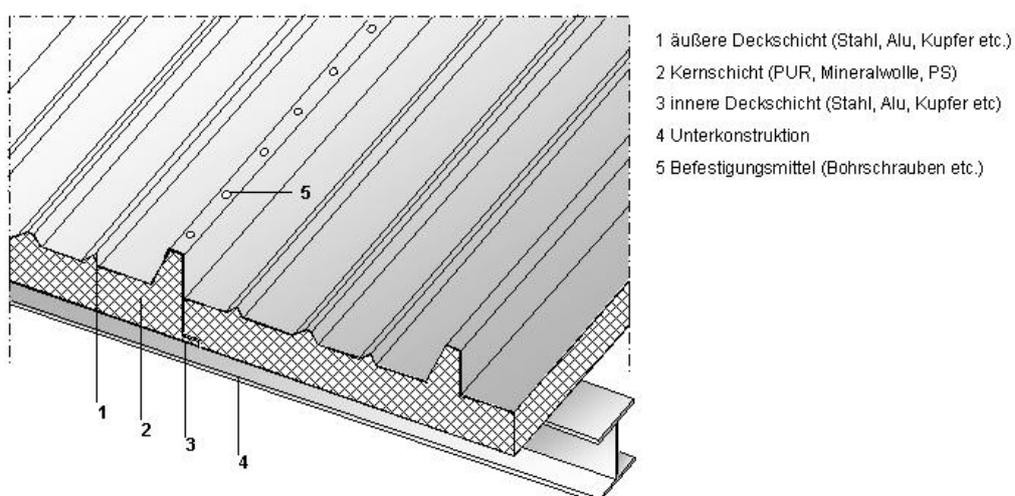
Aufbau und Bezeichnung einer Dacheindeckung in Sandwichbauweise
